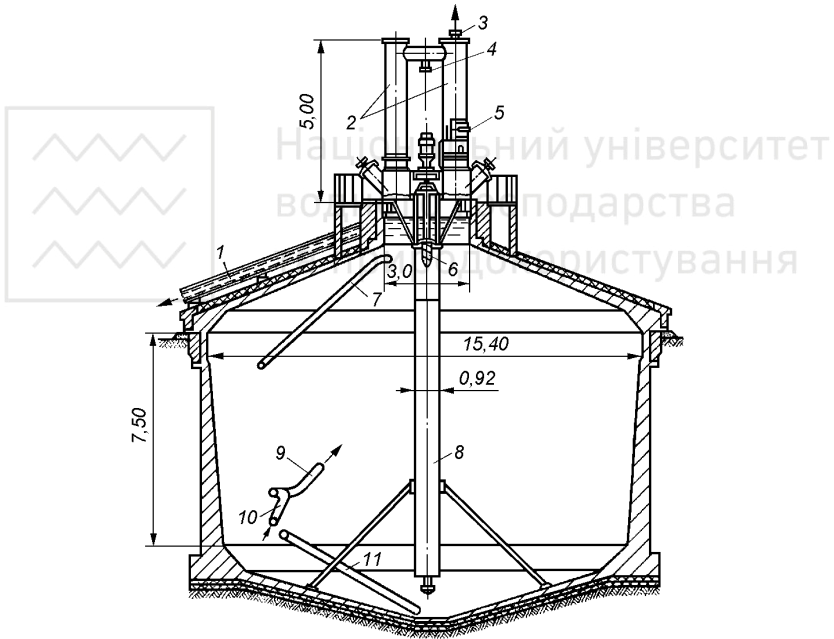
Метантенк з нерухомим незатопленим перекриттям:
